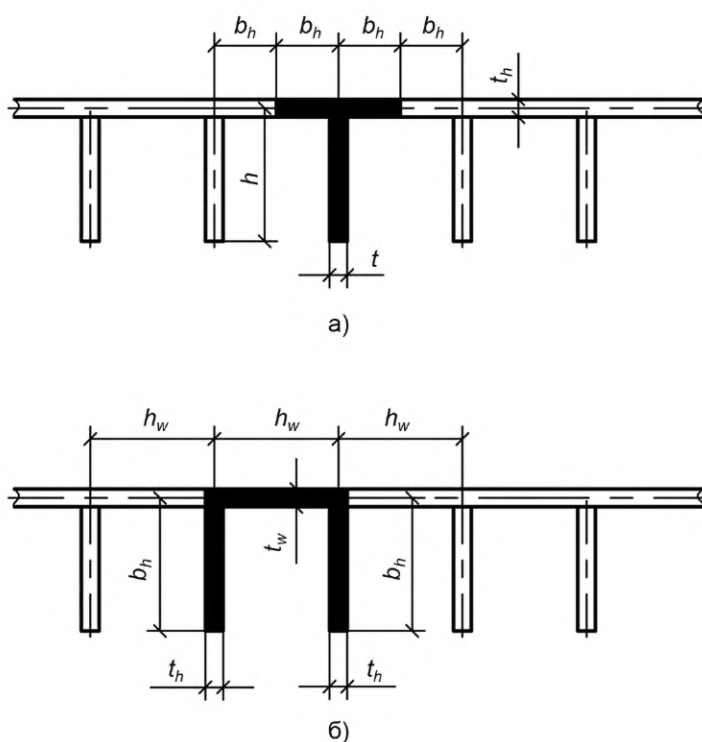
Схемы расчетных сечений пластинок ортотропных плит. Расчетные длины
